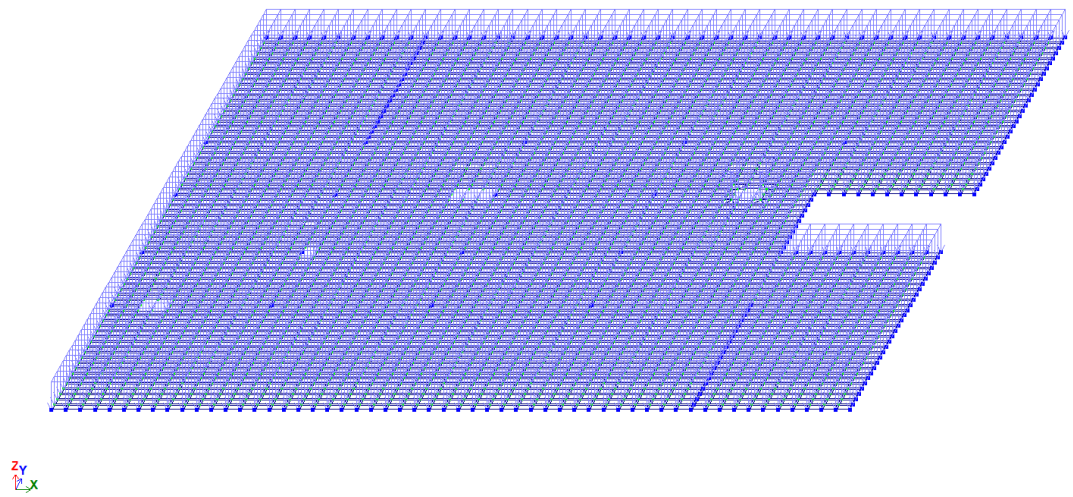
Расчетная схема плиты перекрытия с приложенной нагрузкой
